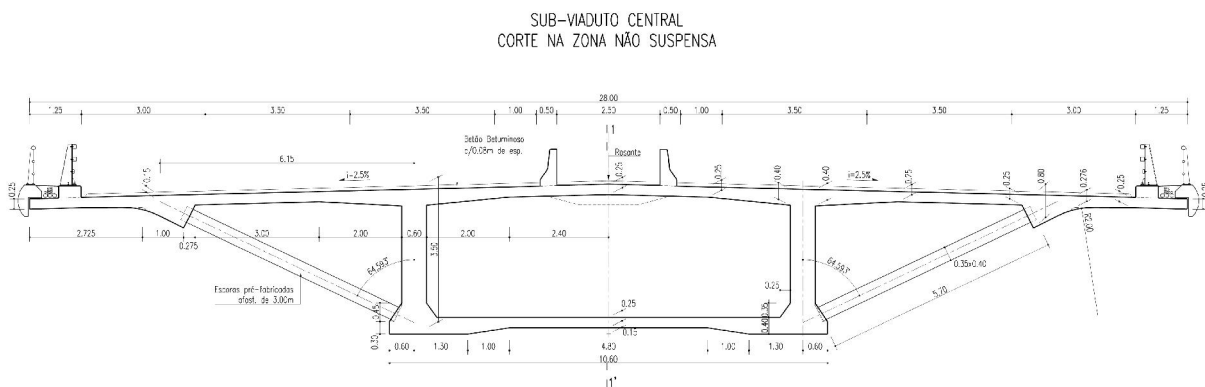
Corte transversal numa zona não suspensa (AutoestradasXXI [et al.], 2010d).
